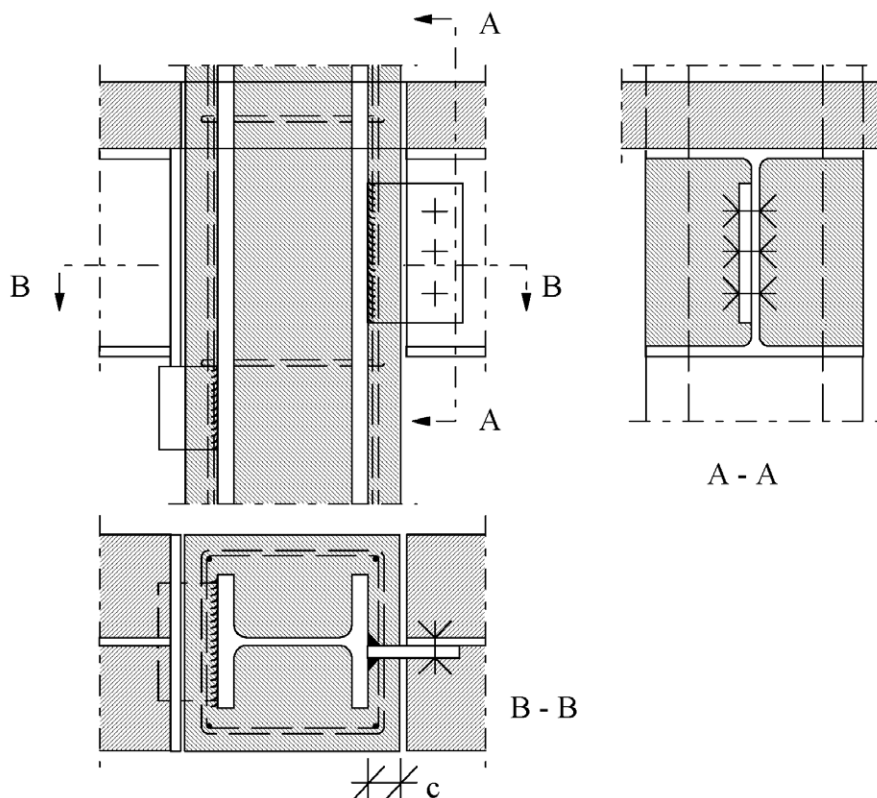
Ejemplos de conexiones a un perfil de un pilar de acero totalmente embebido
